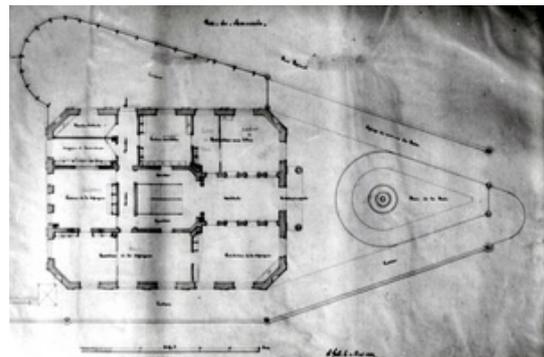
Lausanne, Postgebäude, Plan 3, Grundriss Rez-de-chaussée, ausgeführtes Projekt 1863
